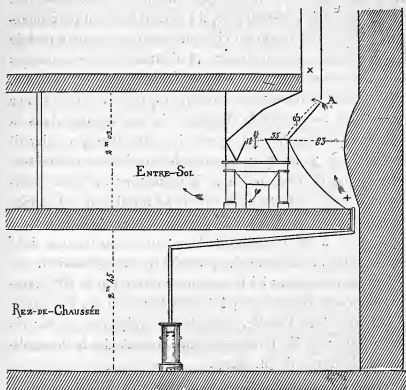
Plan du rez-de-chaussée et du premier étage.
